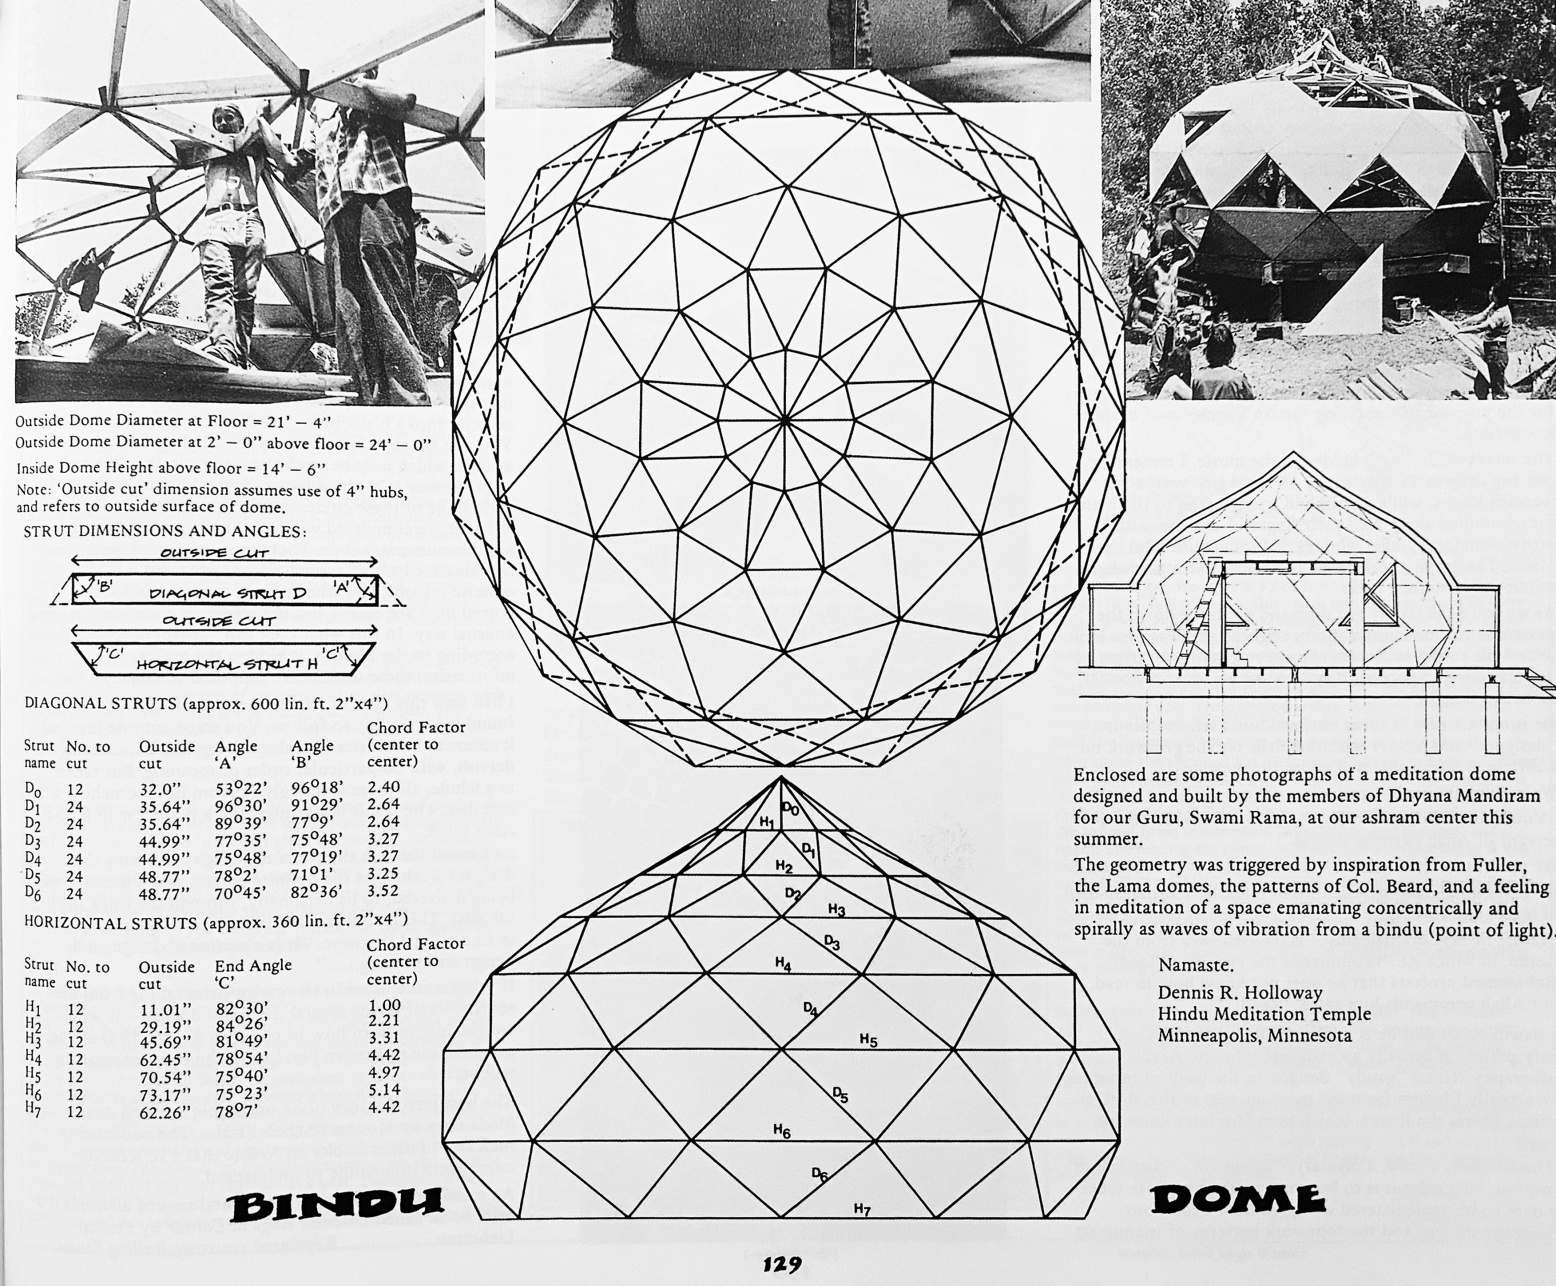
Istruzioni per realizzare una delle molte varianti dei *geodesic dome*. Tratto da Shelter, copyright 1973 by Shelter Publications, Inc. Ristampato con permesso. Shelter Publications/AdventureKEEN.
